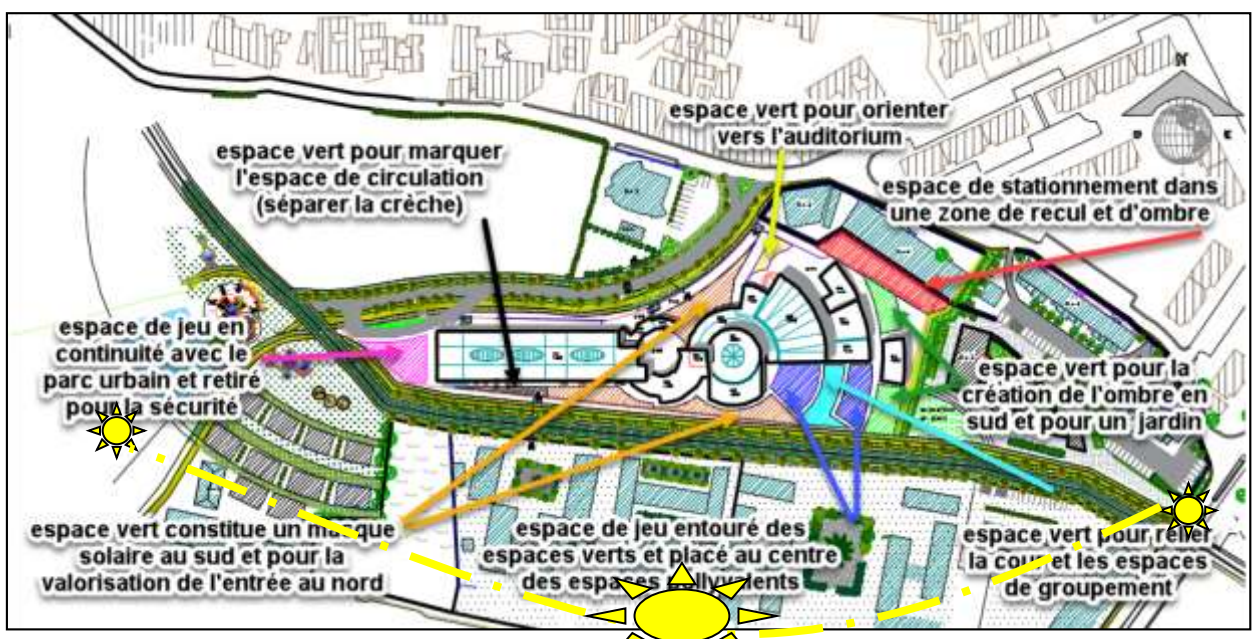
détermination des zones de plan de masse de groupe scolaire. Source : auteurs.
